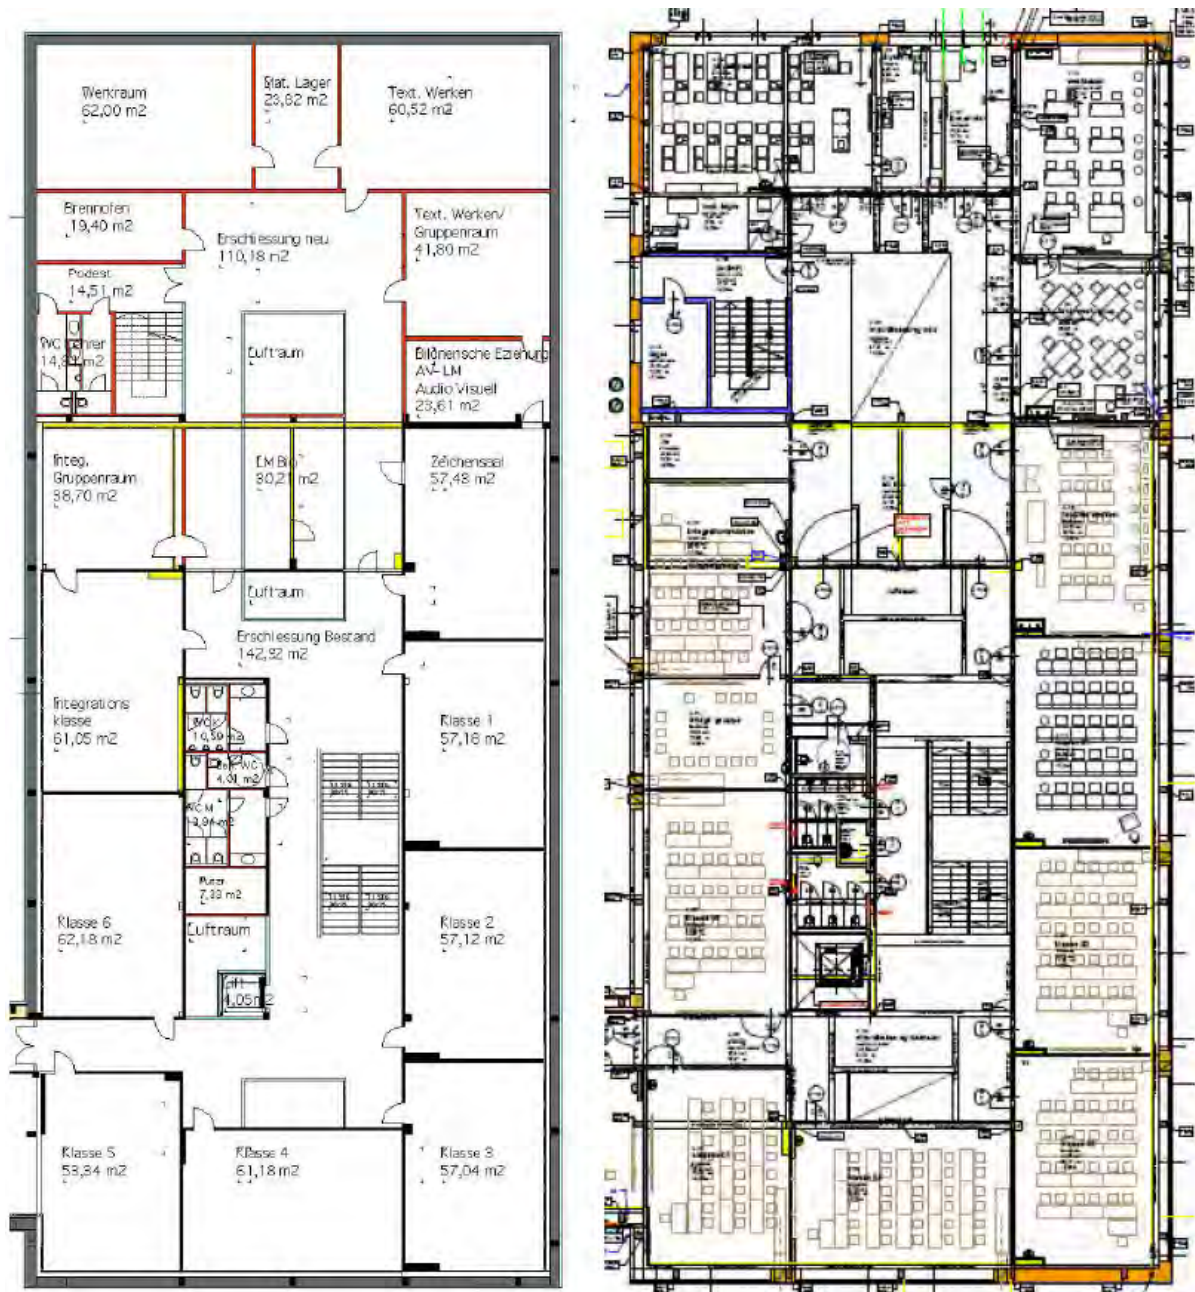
Passivhaus-Schule Schwanenstadt – Planauszug: Grundriss 1. OG Hauptschule II [PLÖ08]
